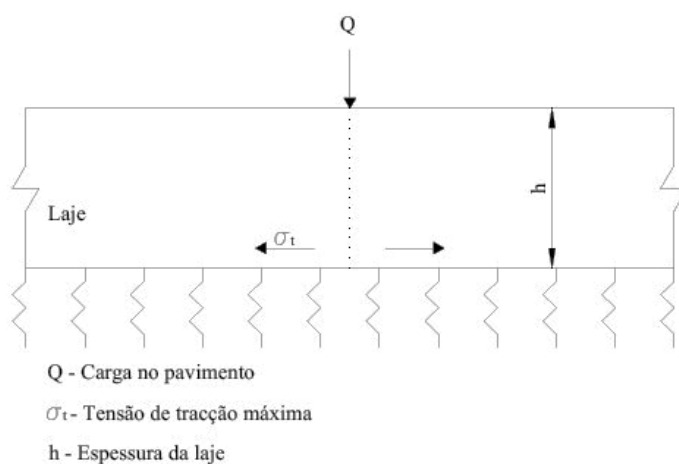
Modelo de laje e fundação de Westergaard (adaptado de OLIVEIRA, 2000)
